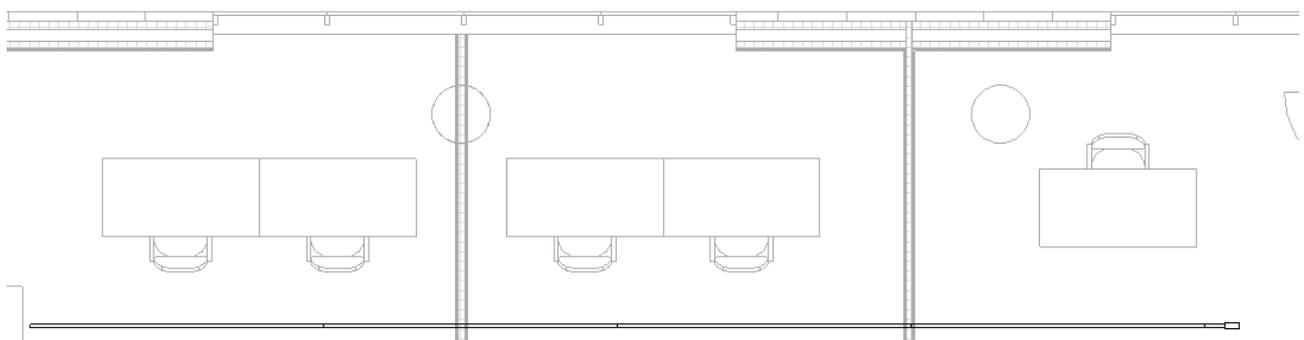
Condotto sbarre a dettaglio Alto in pianta
